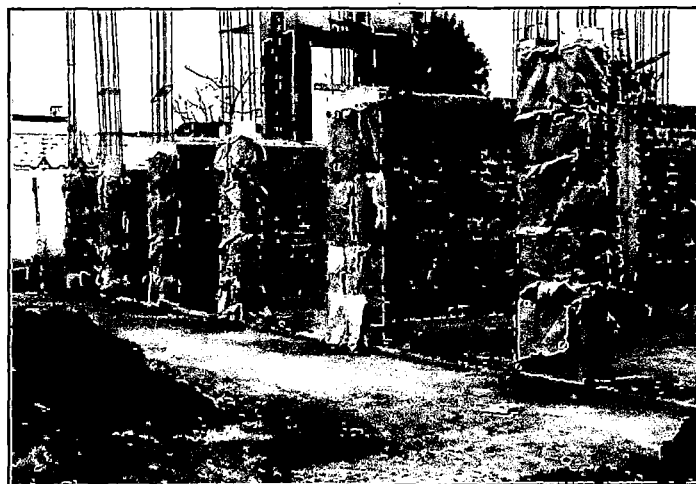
Protección con bolsas de cemento y amarradas con soguilla.
